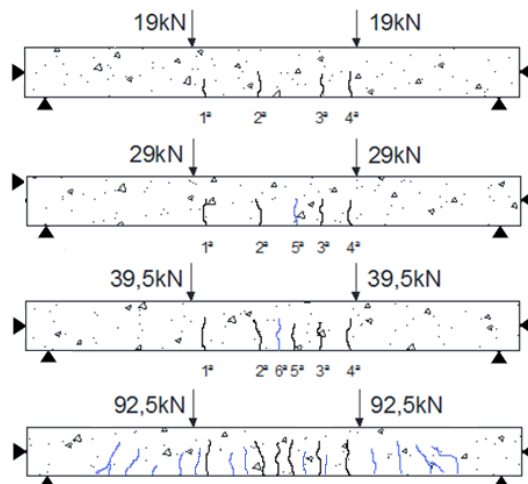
Formação e evolução das fissuras da Viga6old.
